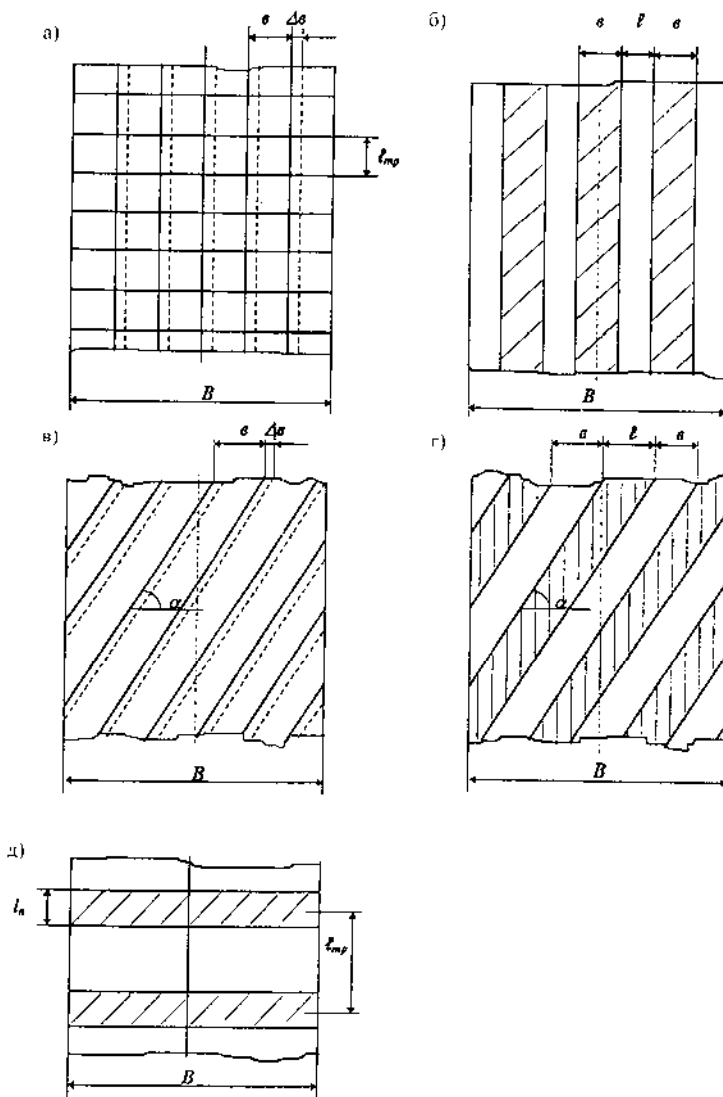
Схема раскладки рулонного материала при устройстве армирующих прослоек:
